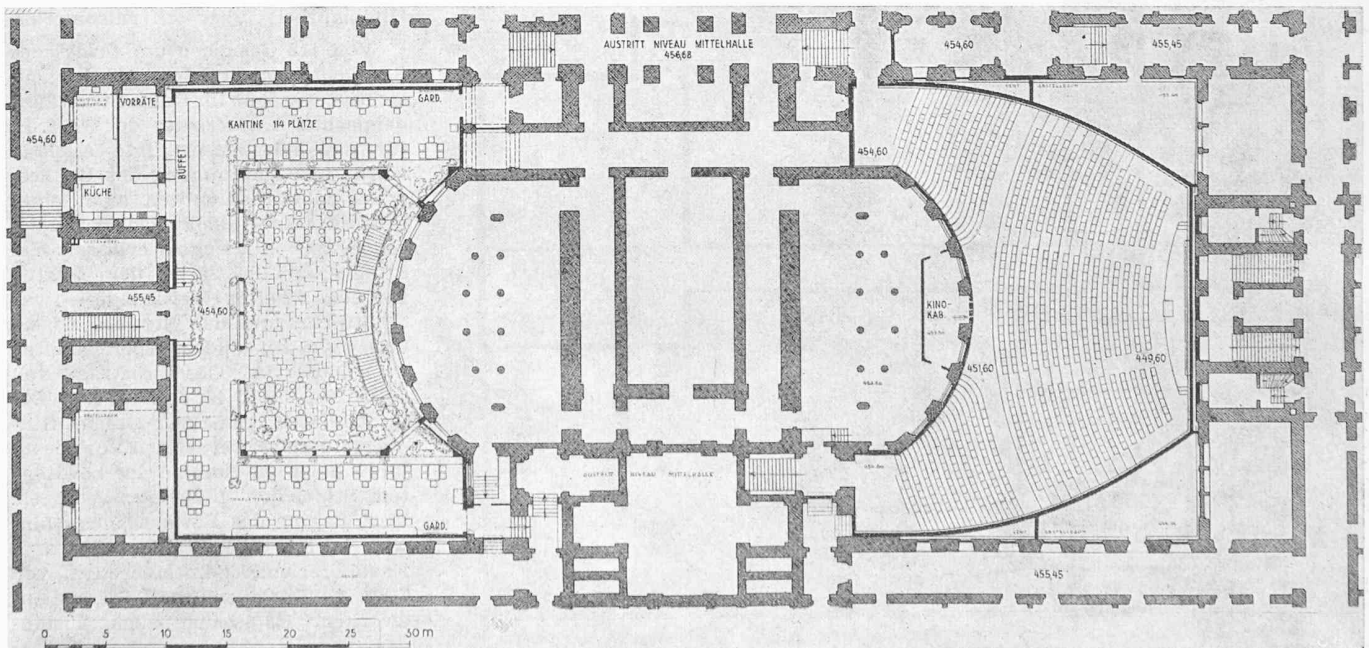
Hauptgebäude der E. T. H. Teilgrundriss A-Geschoss, 1 : 600. — Arch. Prof. Dr. H. HOFMANN
